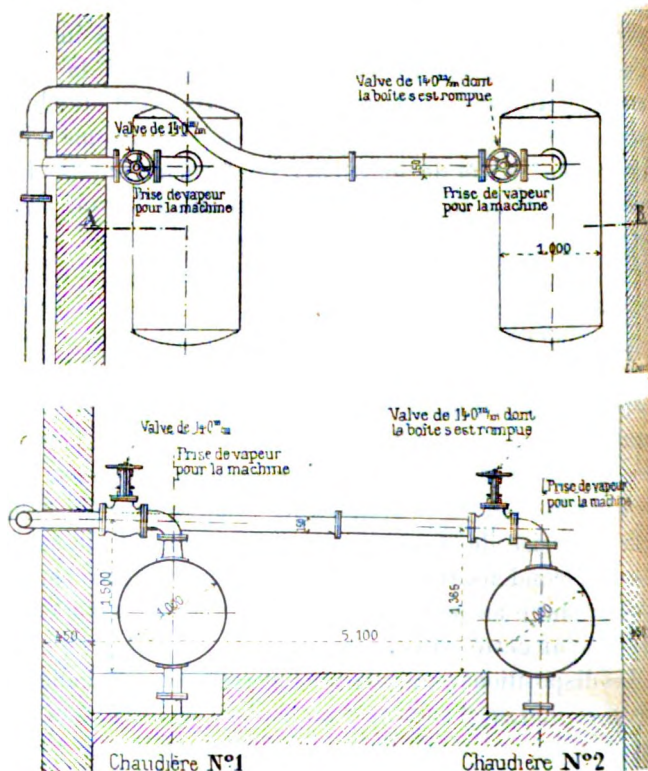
et 10. — Coupe et plan de l'installation, à Wervicq.
